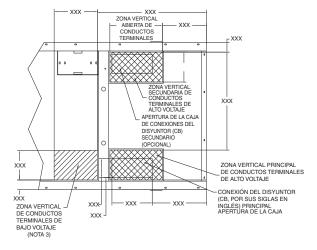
Detalle de los conductos terminales en un plano de instalación típico
